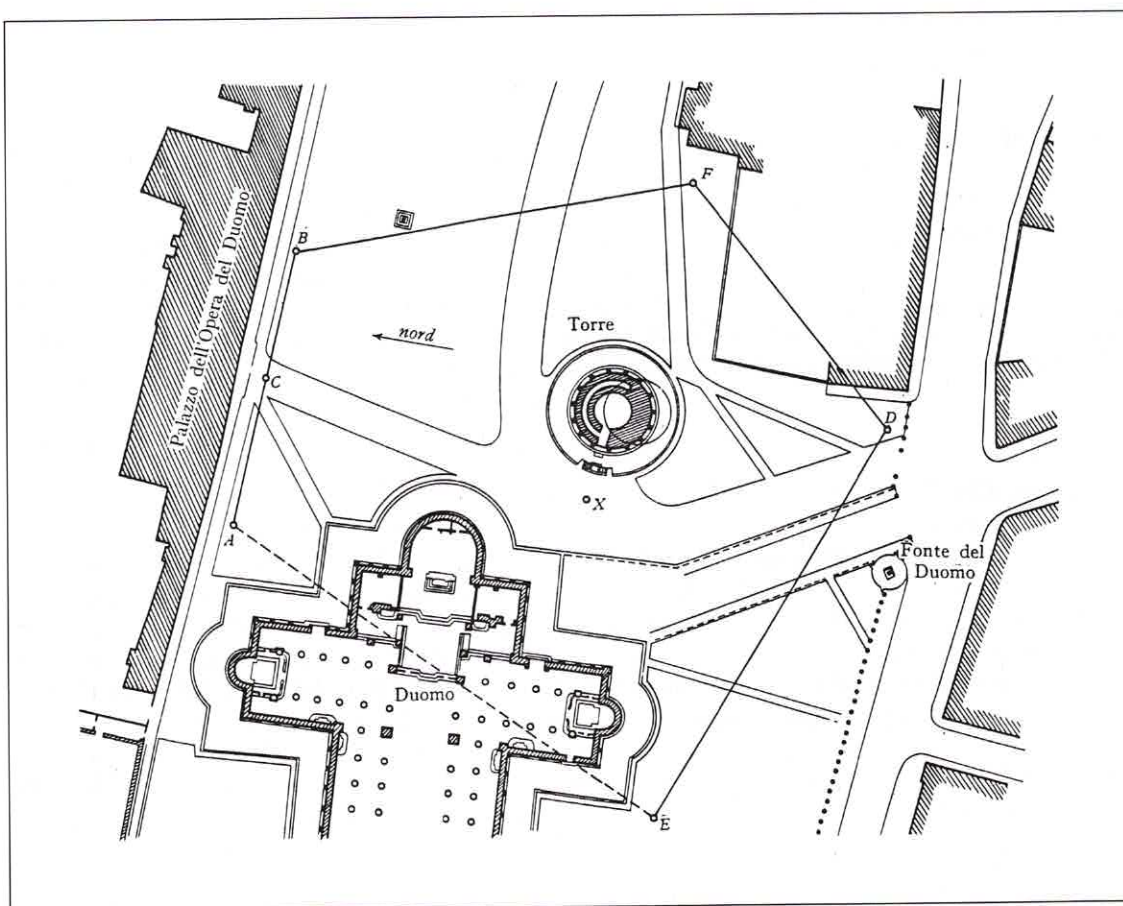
Posizione dei 7 vertici della rete planimetrica tracciata nel 1911
